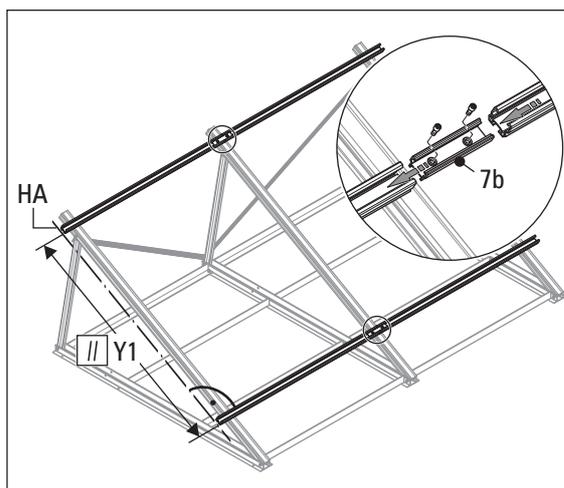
Montar las guías de perfil de montaje, 1er paso
